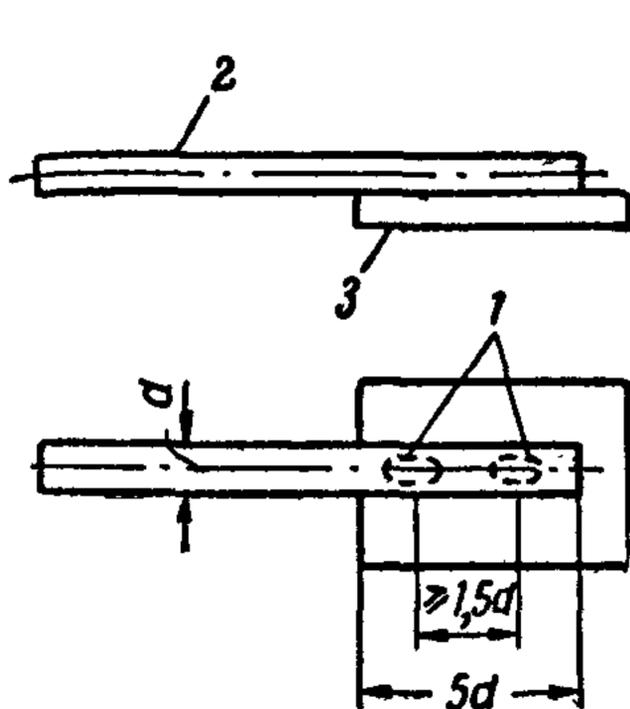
Схемы соединения стержня с плоским элементом закладной детали внахлестку контактной точечной сваркой
